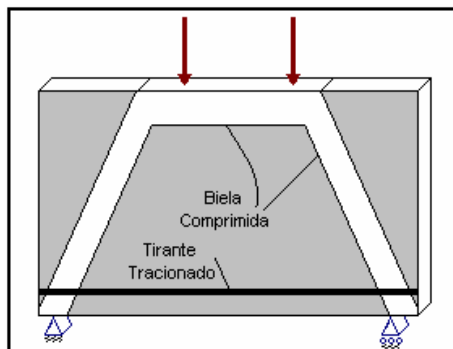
Modelo de bielas e tirantes em vigas-parede (O'BRIEN & DIXON, 1994)
